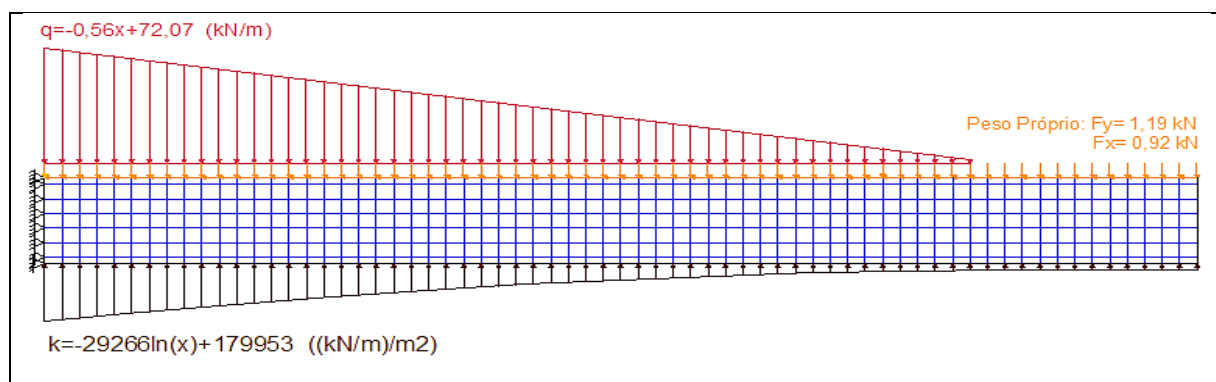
LAJE COM AS FUNÇÕES DA BASE ELÁSTICA E DO CARREGAMENTO – PASSO 8
